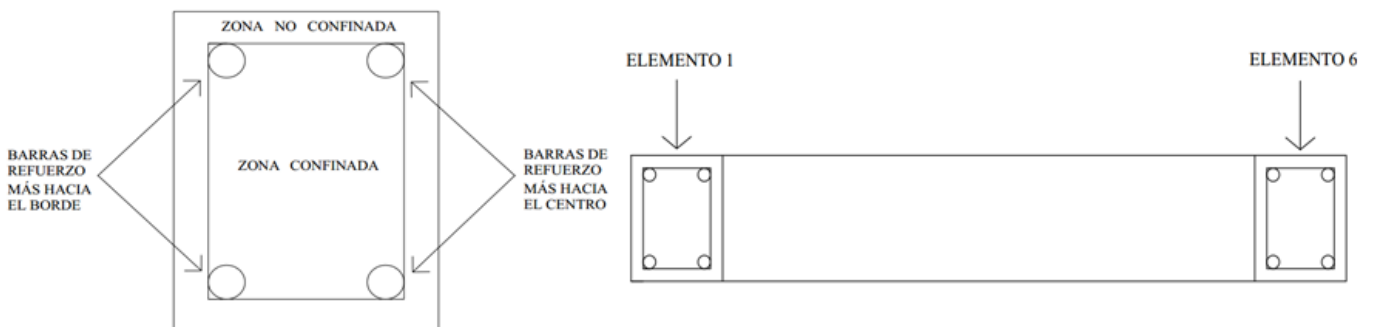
Esquema del elemento 6 con zonas del hormigón y descripción de la ubicación de los elementos 1 y 6 en la planta del muro base.
